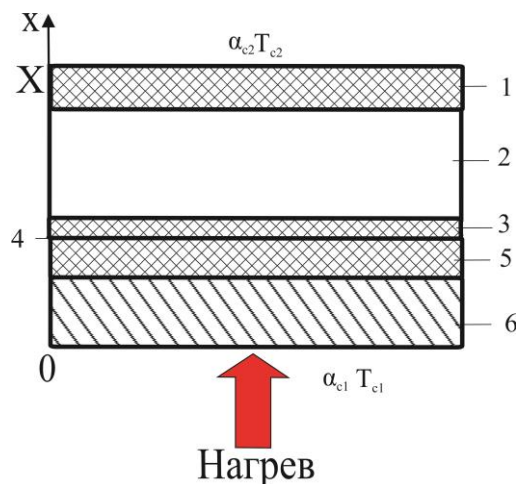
Схема многослойного железобетонного перекрытия в одномерной постановке: 1 – слой сплошного бетона между необогреваемой поверхностью и слоем с пустотами перекрытия; 2 – слой с пустотами; 3 – слой сплошного бетона между пустотами и арматурой; 4 – слой арматуры; 5 – слой сплошного бетона от арматуры до обогреваемой поверхности; 6 – штукатурное покрытие.
